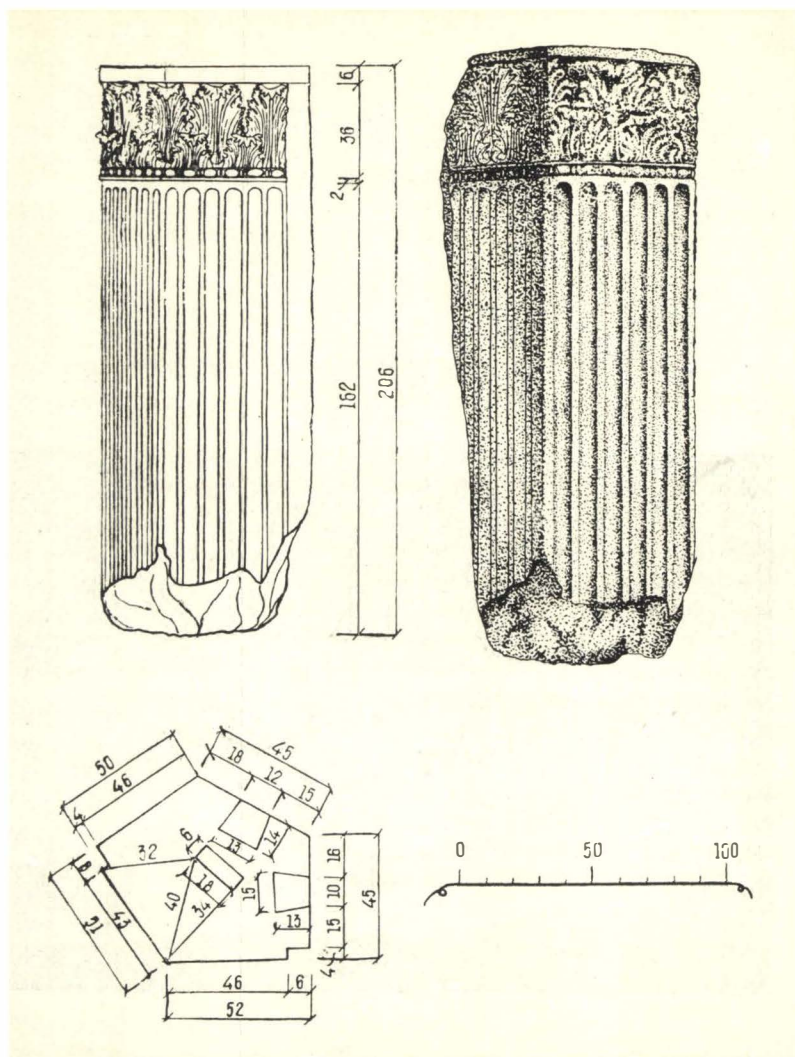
Perspectivă și secțiune prin pilastrul de colț al construcției hexagonale, etajul inferior.
